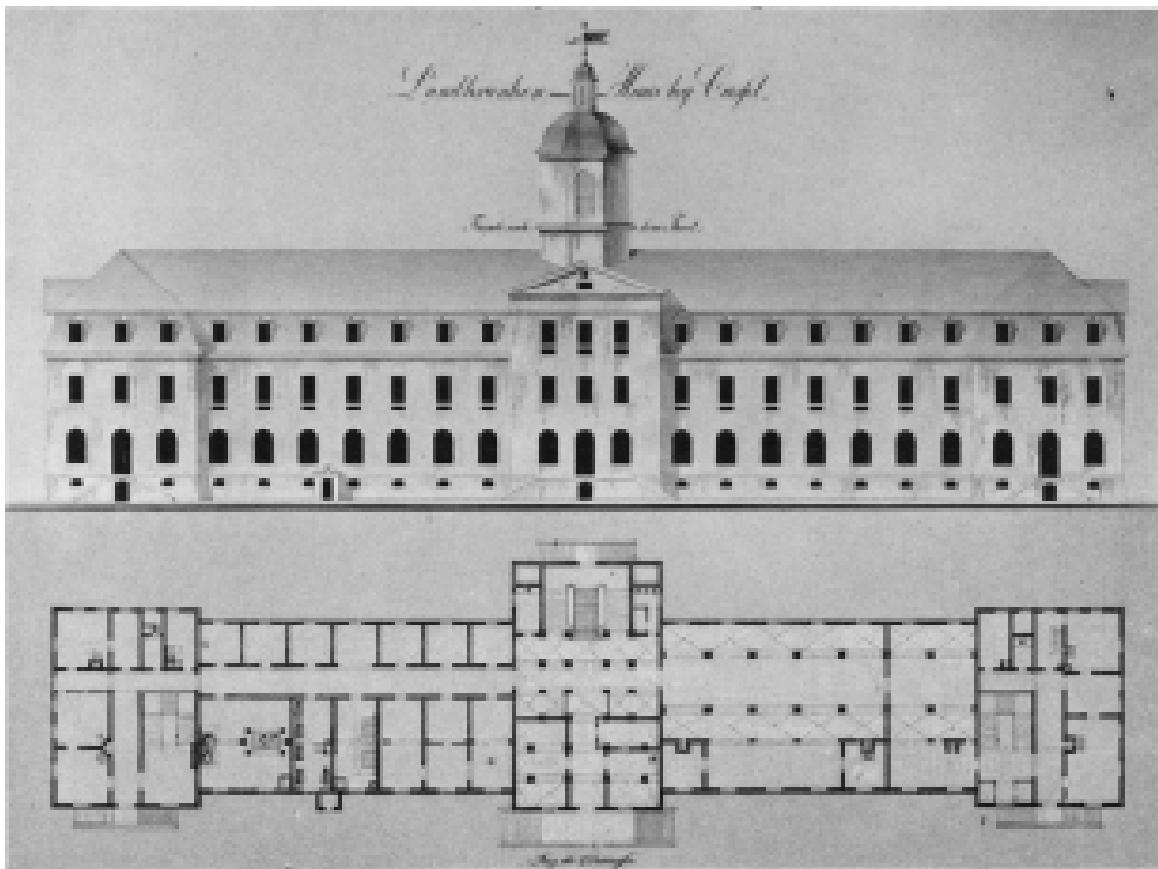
Charité Aufriss und Grundriss, Erdgeschoss
